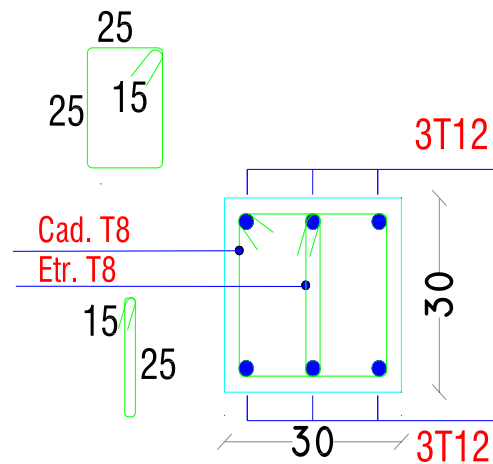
coupe de ferrailage des longrines aux niveaux d'appuis et travée
